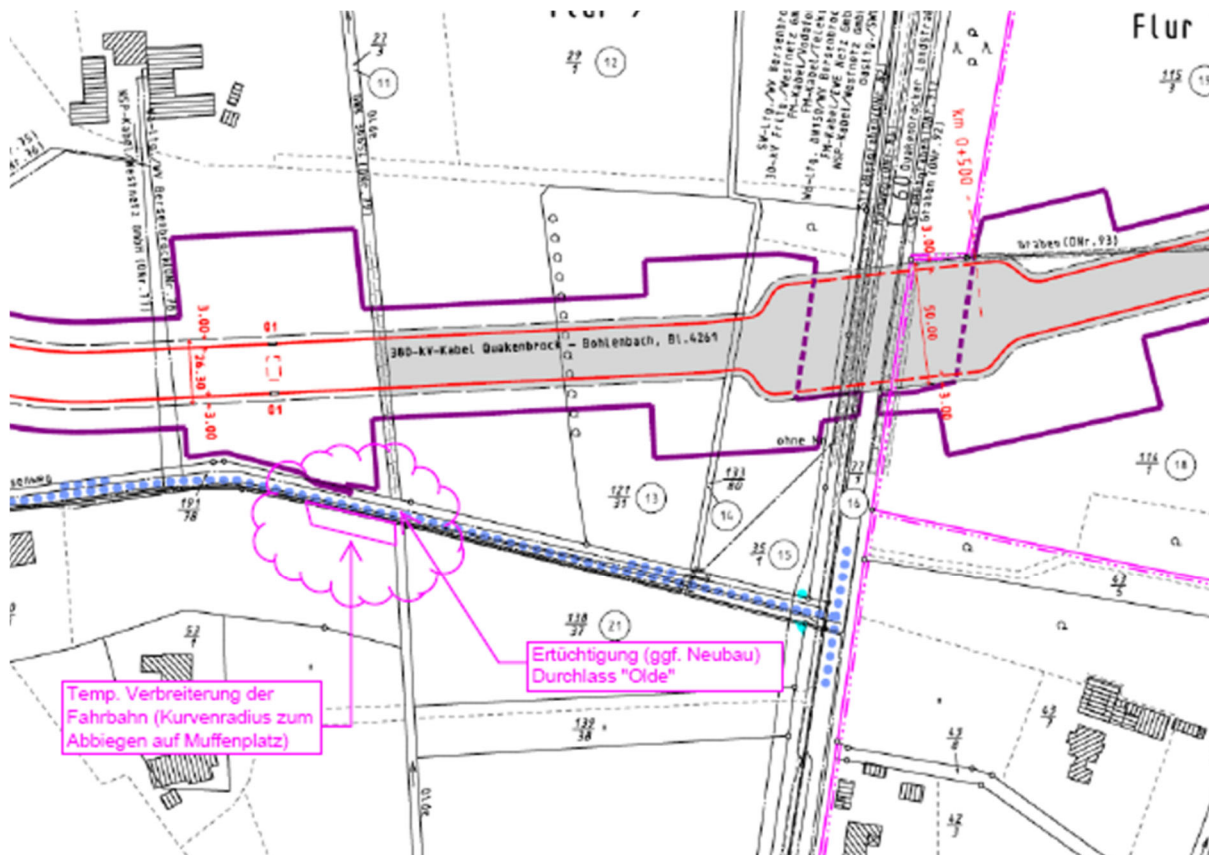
Ausschnitt aus Lageplan zur Änderung der Zufahrt im Bereich der Muffe Q1
